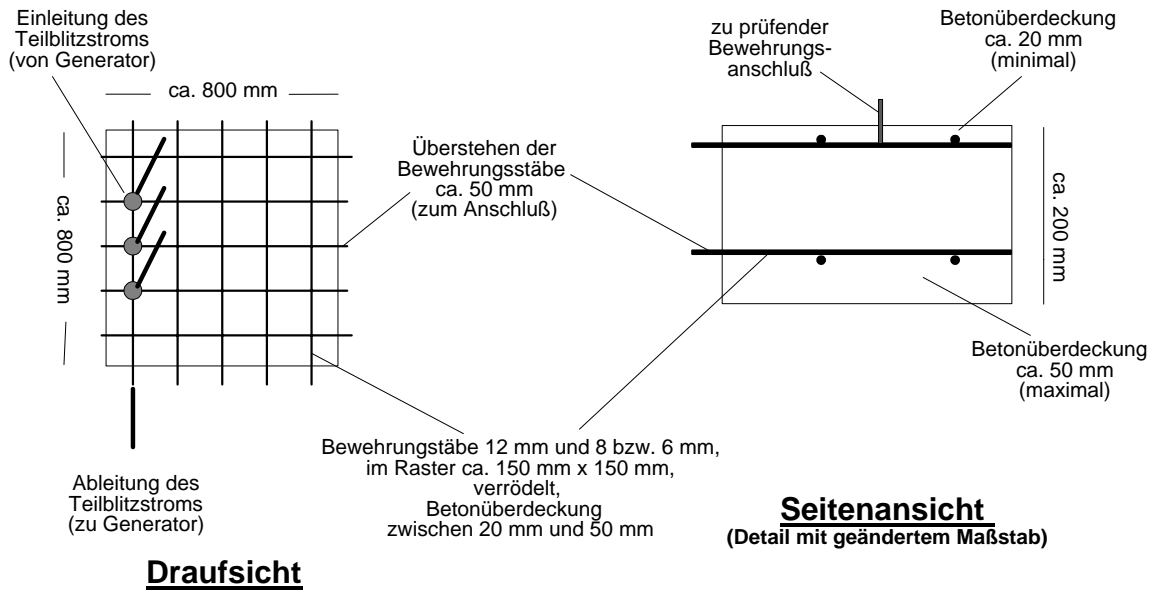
Prüfling B: Betonplatte 800 x 800 mm² mit mehreren Anschlüssen.
